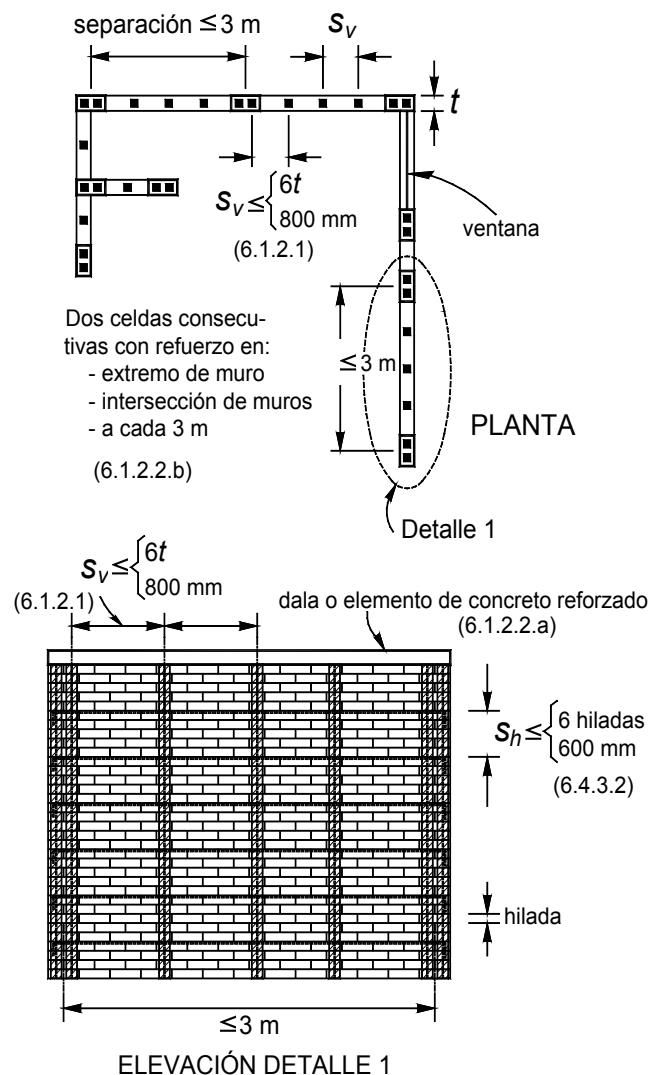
Requisitos para mampostería con refuerzo interior
